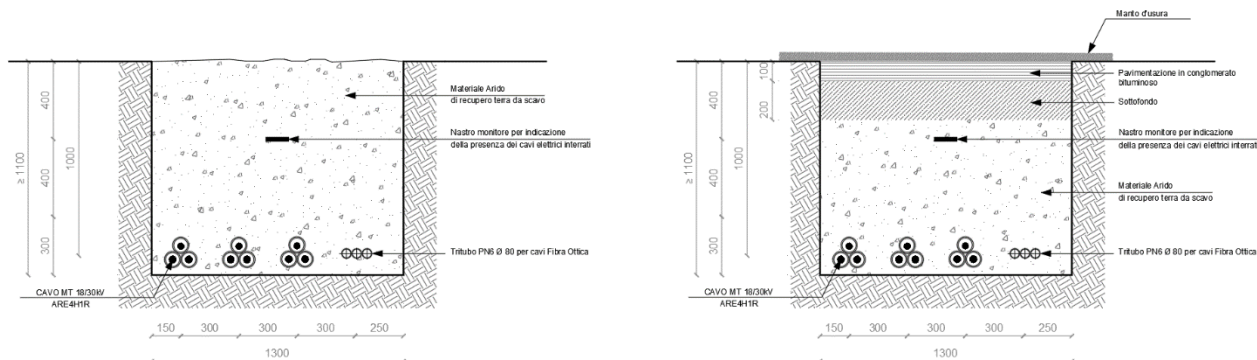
Tipico modalità di posa cavo MT 30 kV (sezione tipo C)
